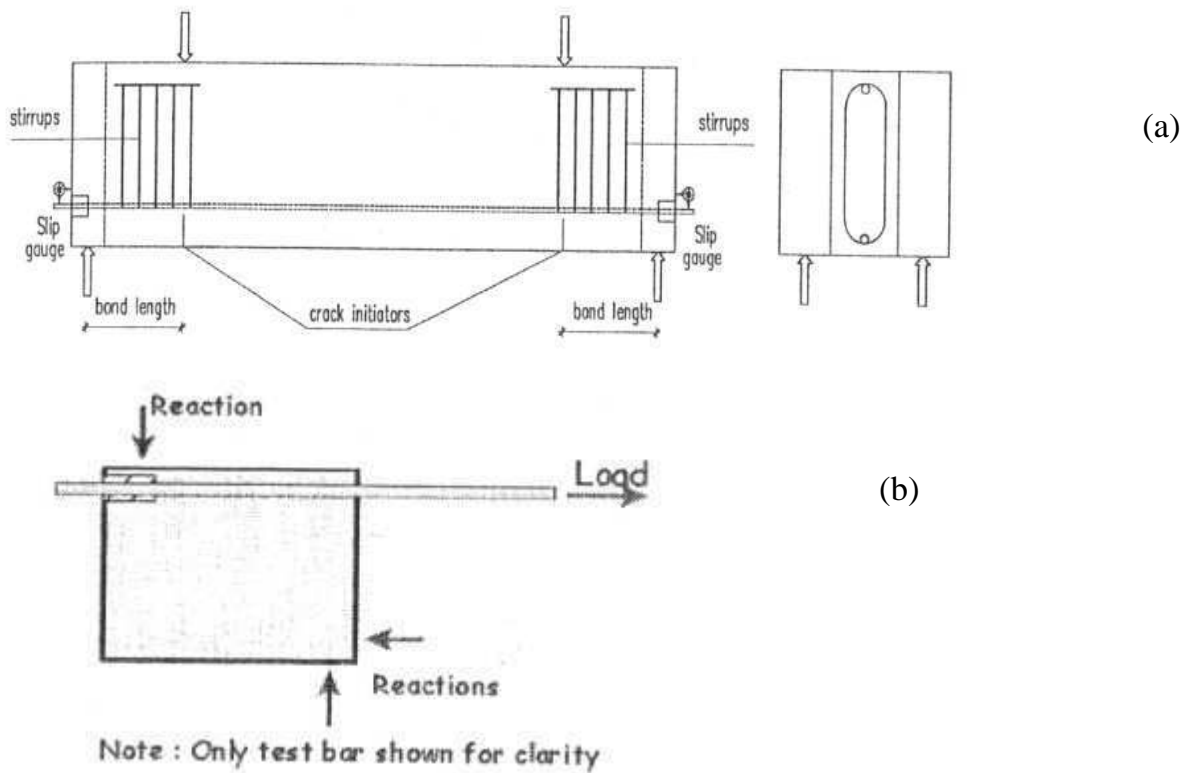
Test classique de poutre (a), et test du bord de poutre (b).
